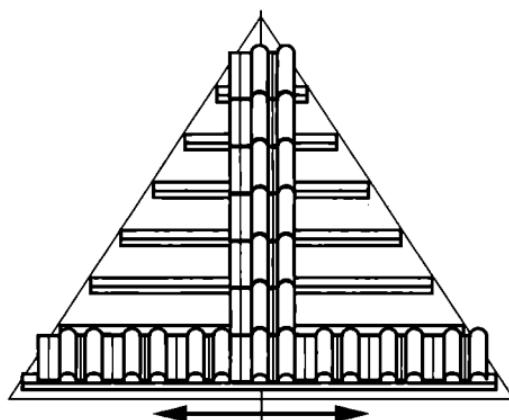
Укладка натуральной черепицы на треугольных скатах
